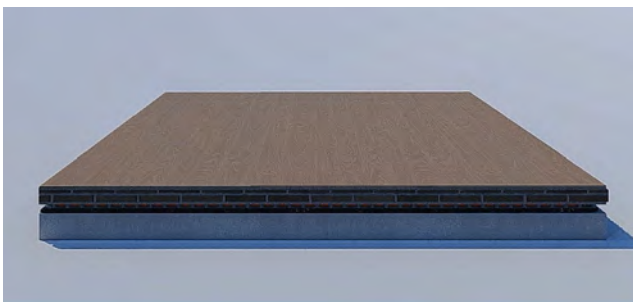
Estructura de sistema de calefacción por suelo radiante.
